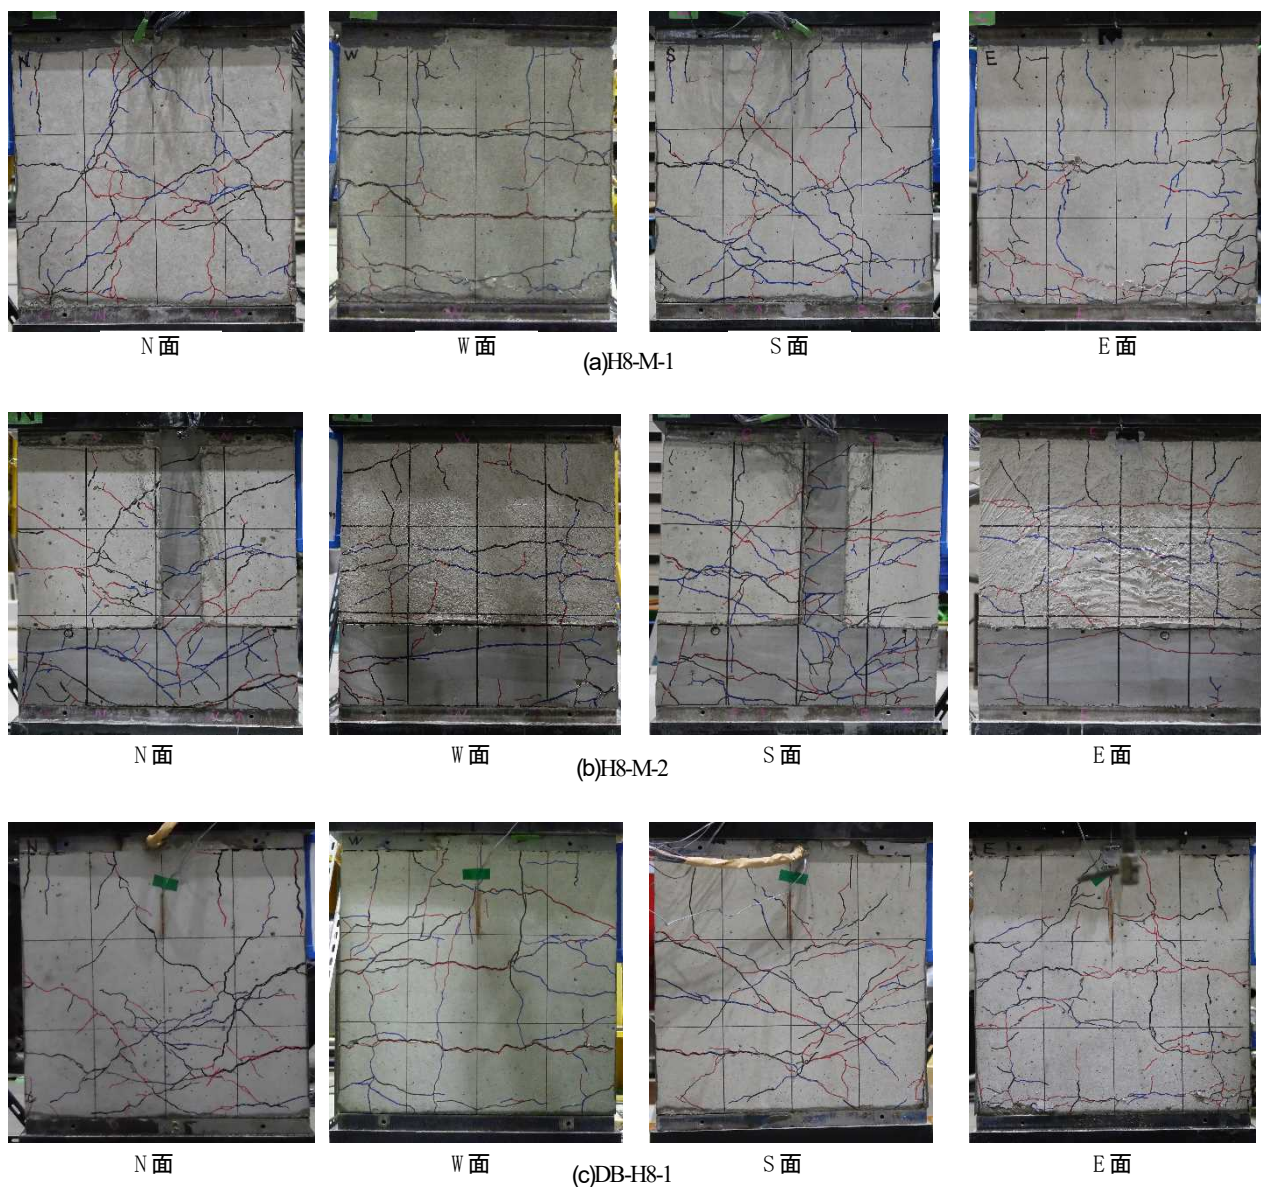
ひび割れ状況（載荷完了 残留変位時）
